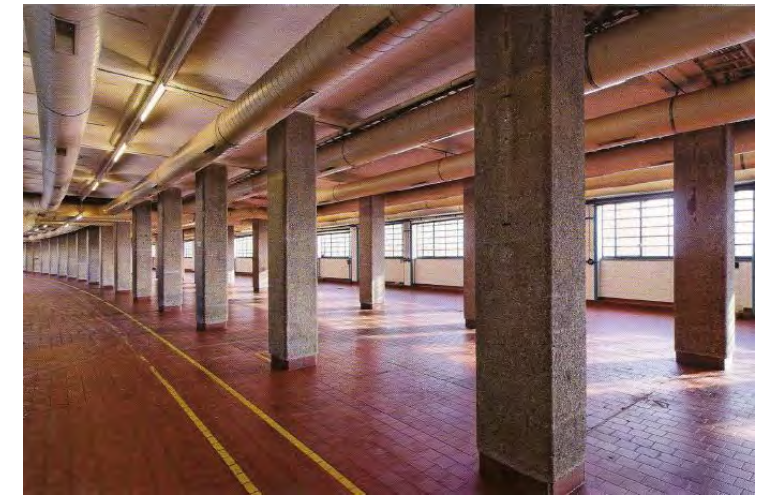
Zigarettenfabrikationsgebäude, Leerstand, Foto
